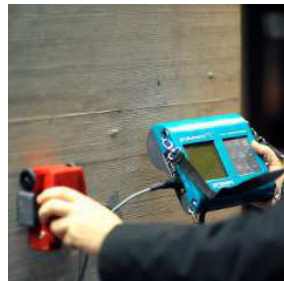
Bewehrungssuchgerät<sup>334</sup>
